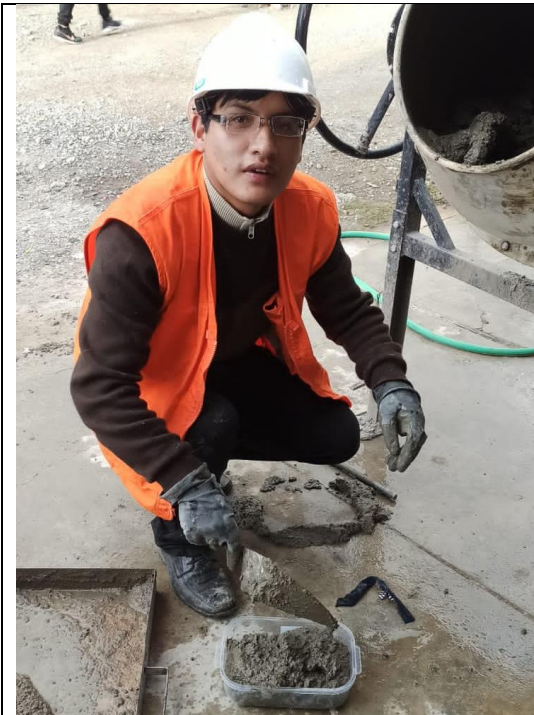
Elaboración en el llenado de concreto en las probetas cilíndricas.
